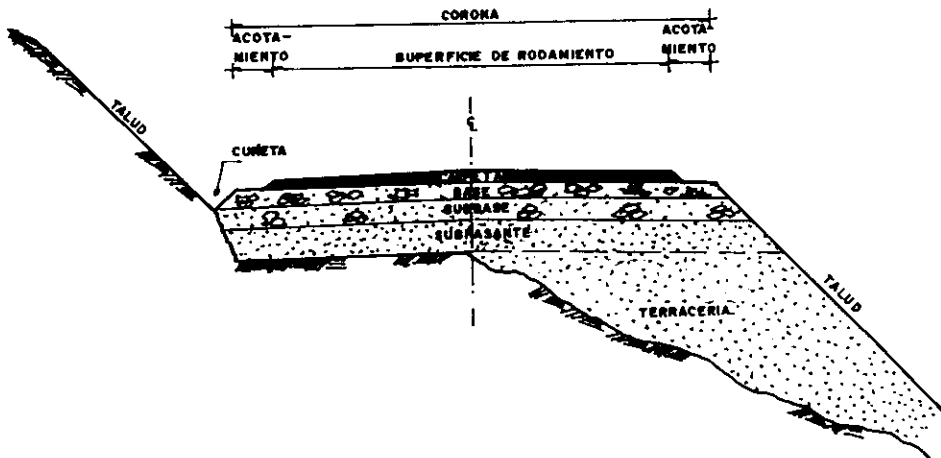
,1 Sección Transversal de un Pavimento Flexible.
